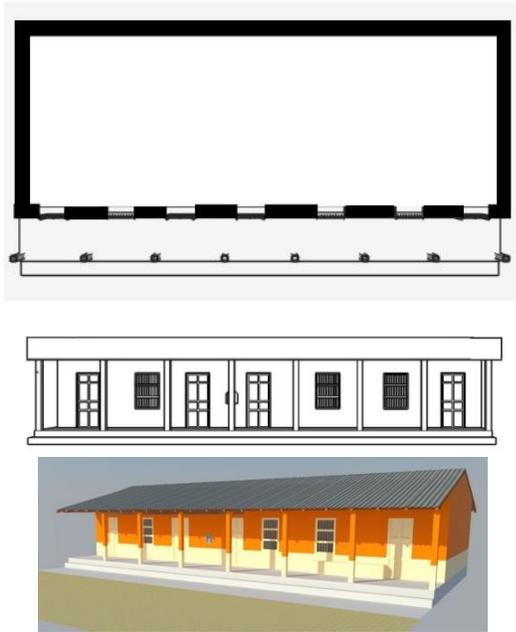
Fachada lateral, fachada frontal y modelo 3D.
